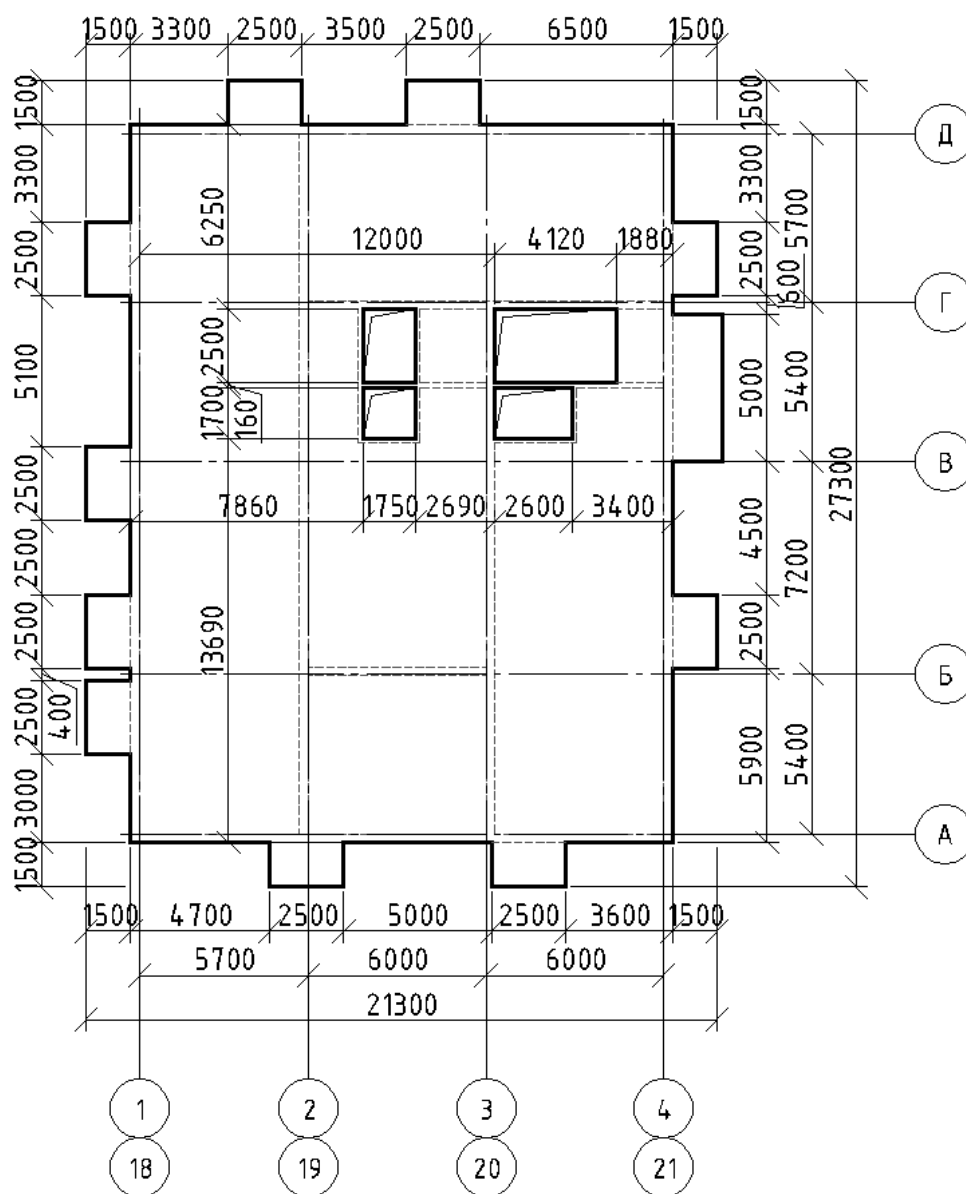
Расчетная схема монолитной плиты перекрытия на отметке +46,800
